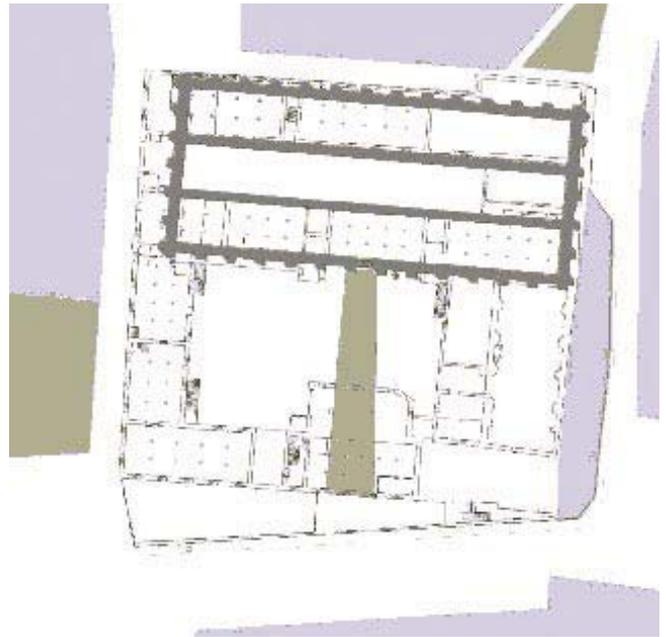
Restitución de la planta de la casa de Hernando Colón.
